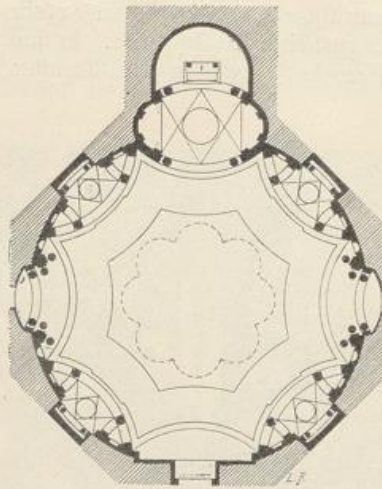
Grundriss von S. Lorenzo zu Turin
